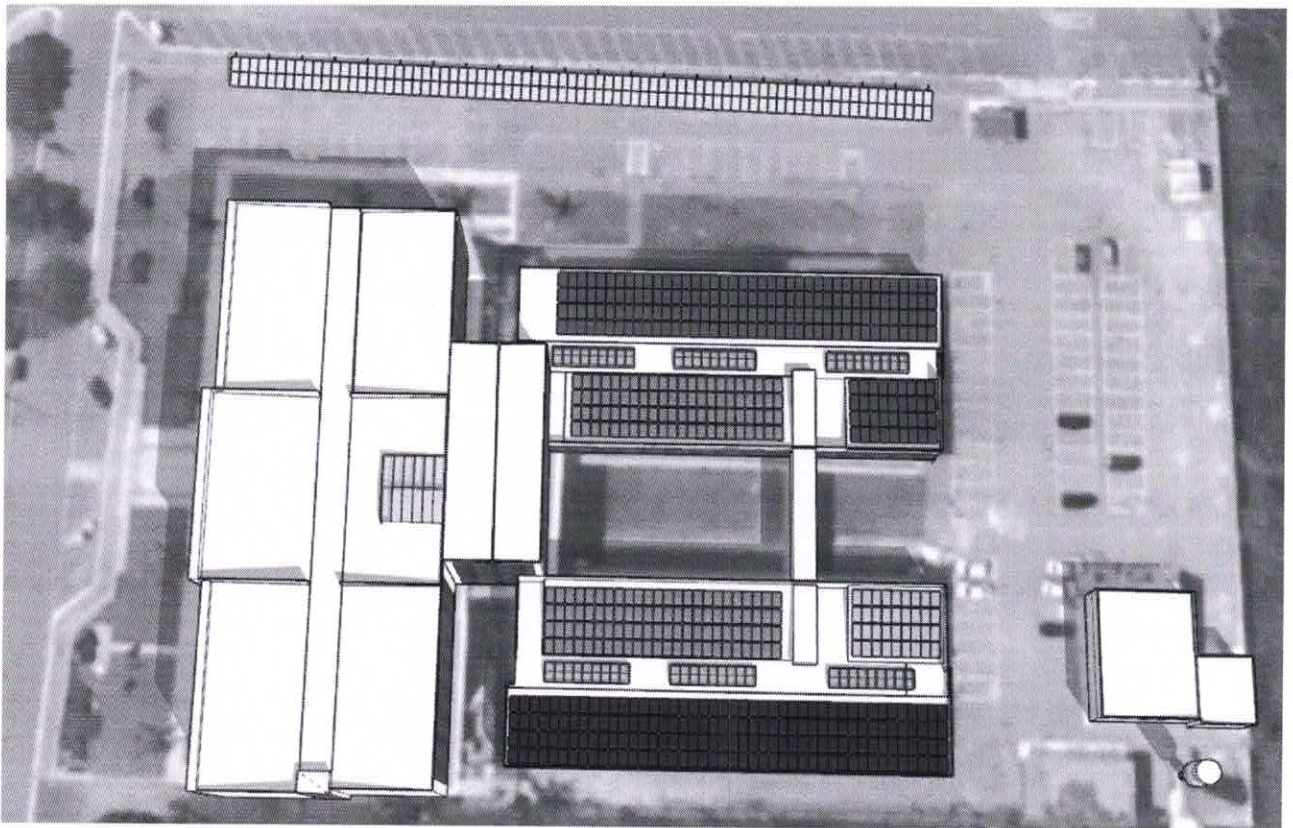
PLANTA DE SITUAÇÃO – ANEXO 1
